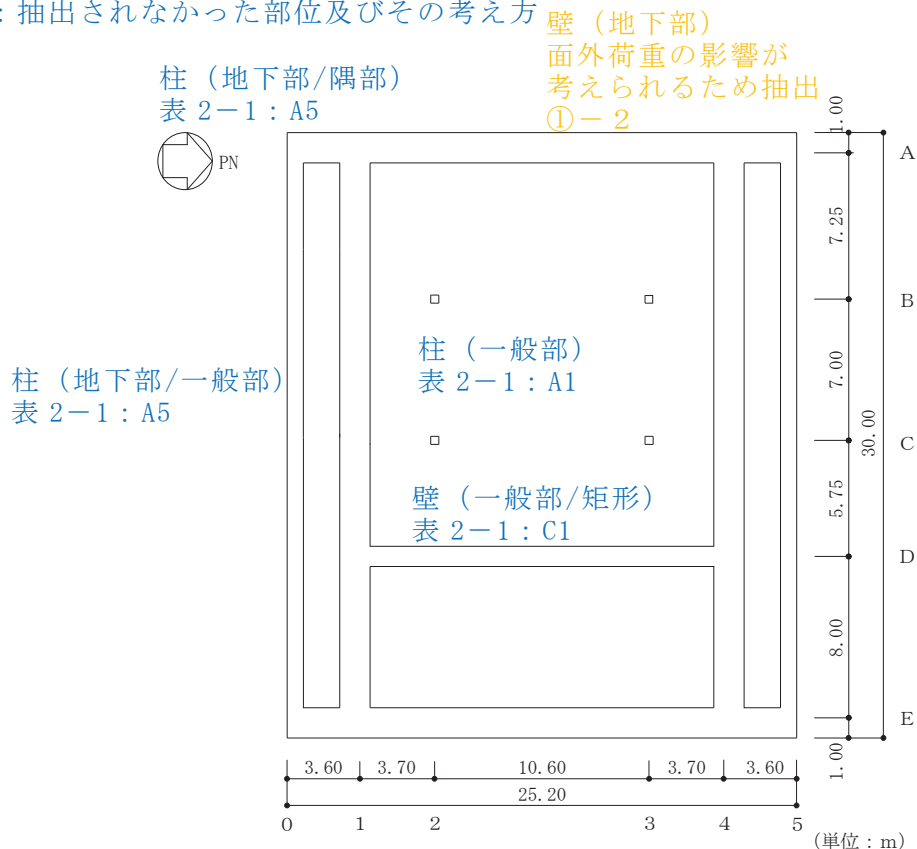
(1) 緊急用電気品建屋の概略平面図 (0.P. \* 56.4m)
